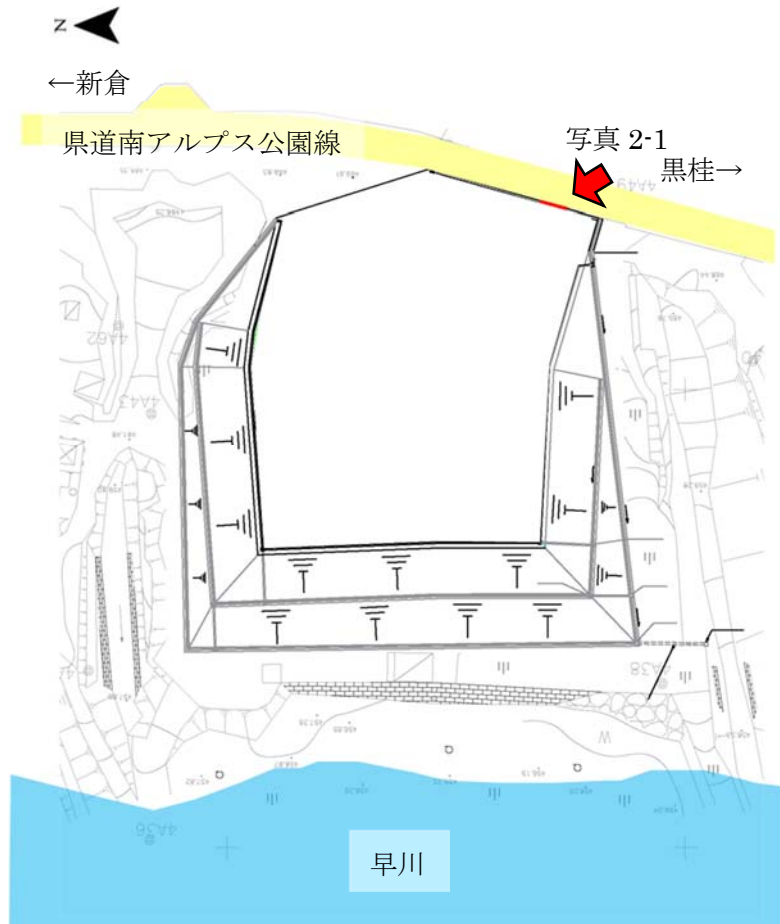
塩島地区（南）発生土仮置き場平面図（現況）
